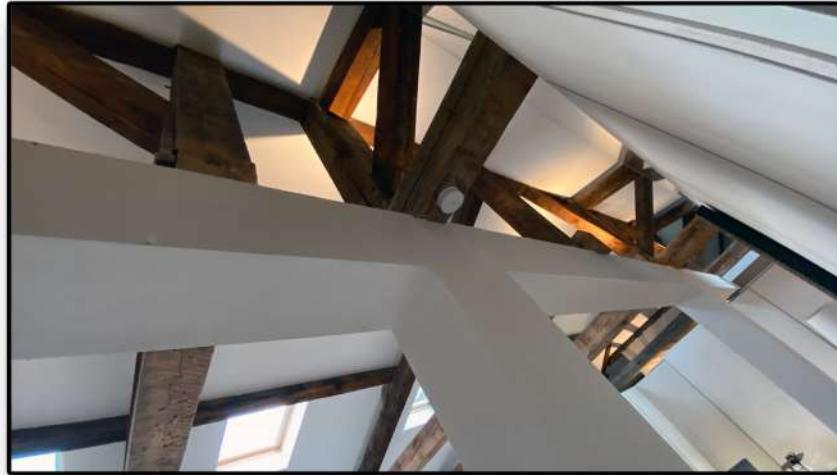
PHOTOS APPARTEMENT 6<sup>ème</sup> ÉTAGE 51 MONTAIGNE
